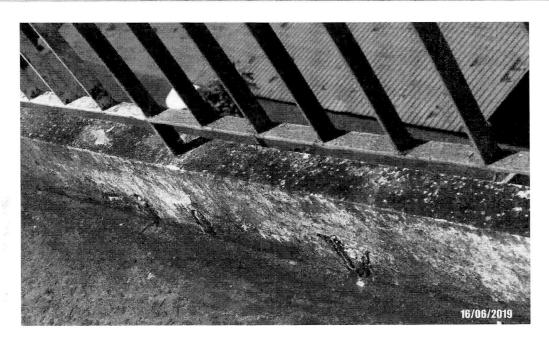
Detalhe da armadura exposta na mureta de fixação do G.C.
